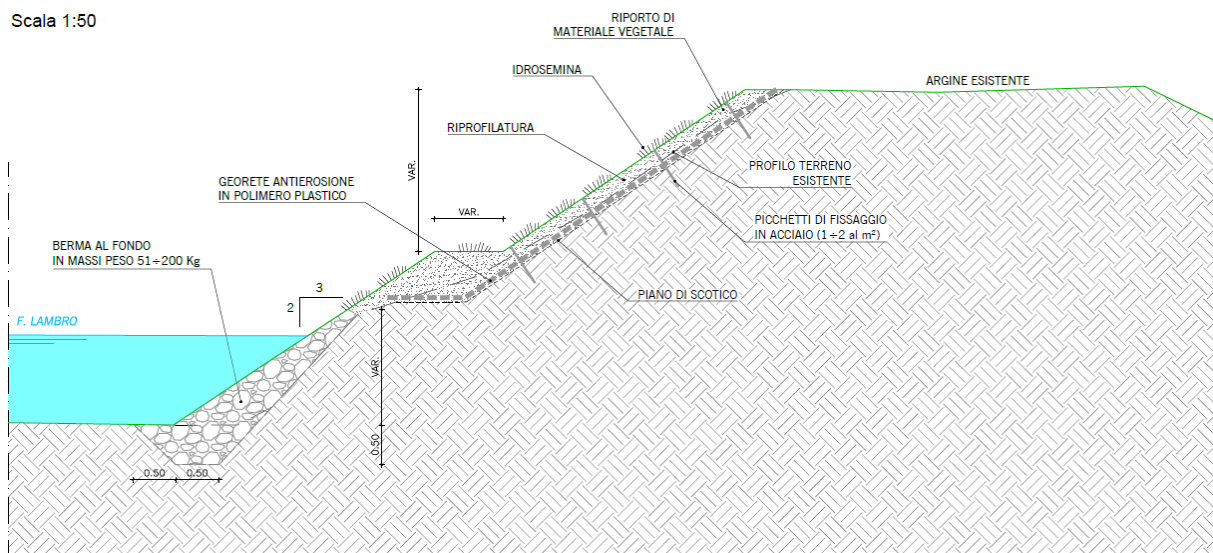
Protezione al piede della scarpata nel tratto Giardini di Via Pisa
